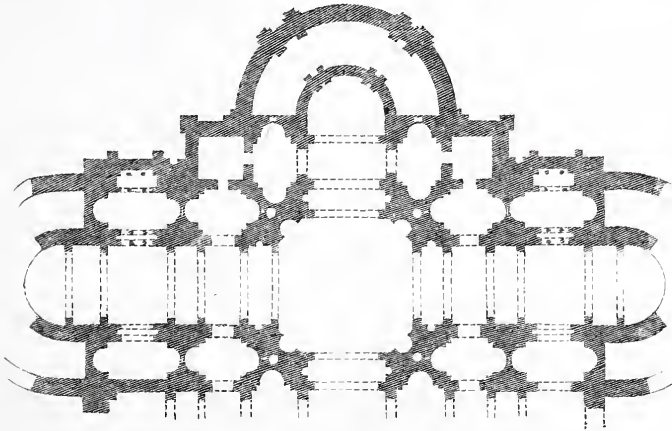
Fig. I. Variante zu dem Plan Giuliano da San Gallo's.
